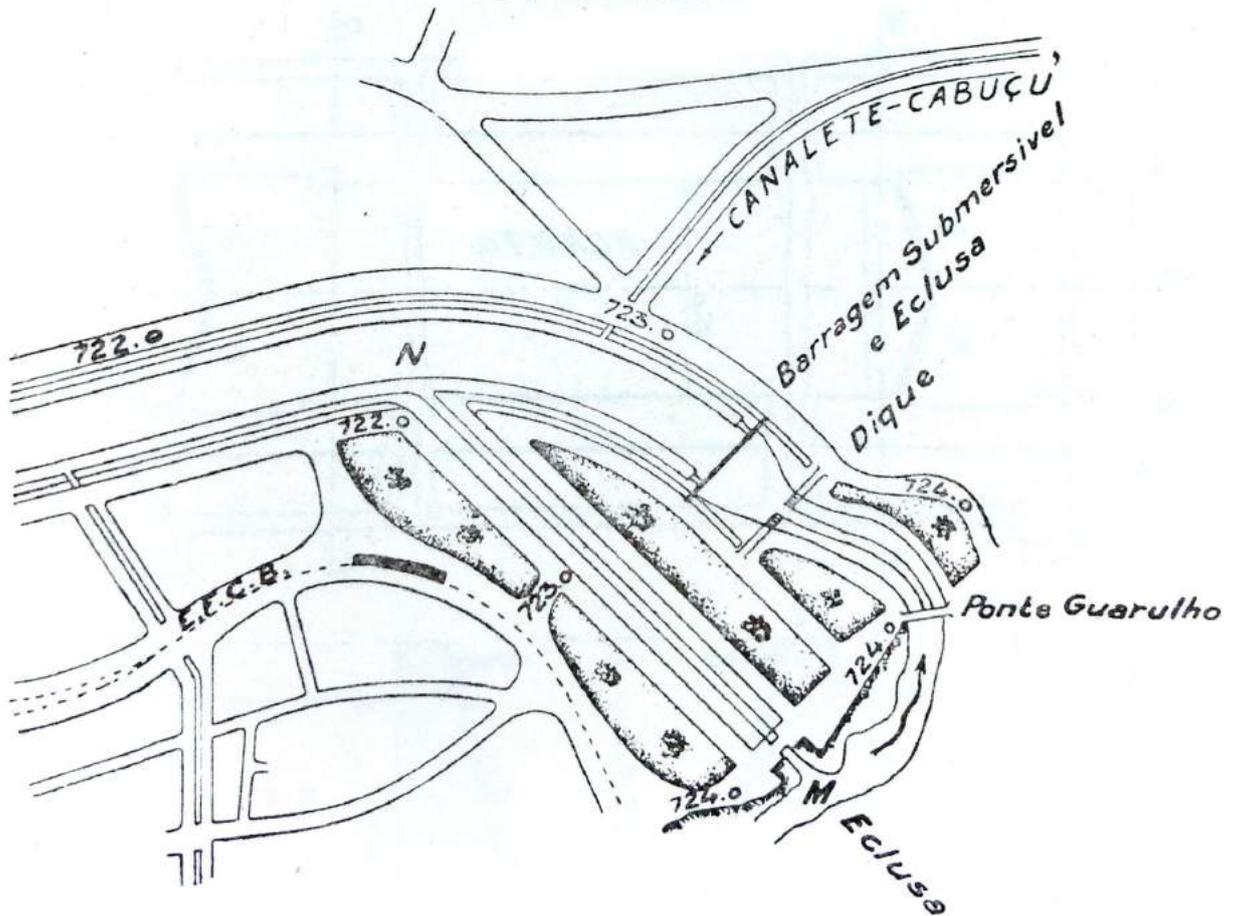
planta barragem da penha, CMRT I Fonte: (BRITO, 1925)
